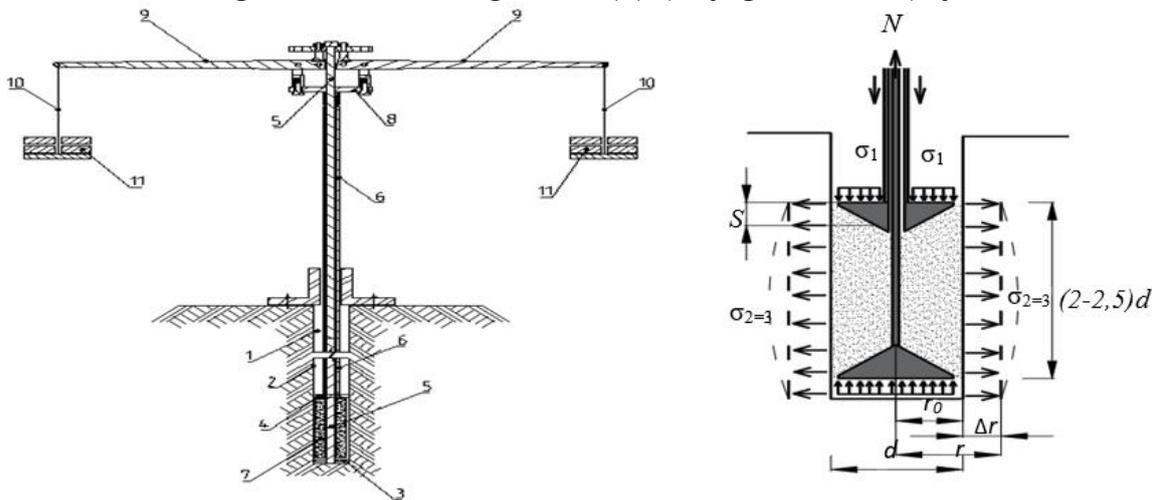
Устройства для определения деформации грунта: 1-скважина; 2- стенка скважины; 3-нижний штамп; 4-верхний штамп; 5-стержень; 6-секция труб (штанга); 7-цилиндр (песок); 8-упорная плита; 9-рычаги с равновеликими плечами; 10-подвеска; 11-гири.
